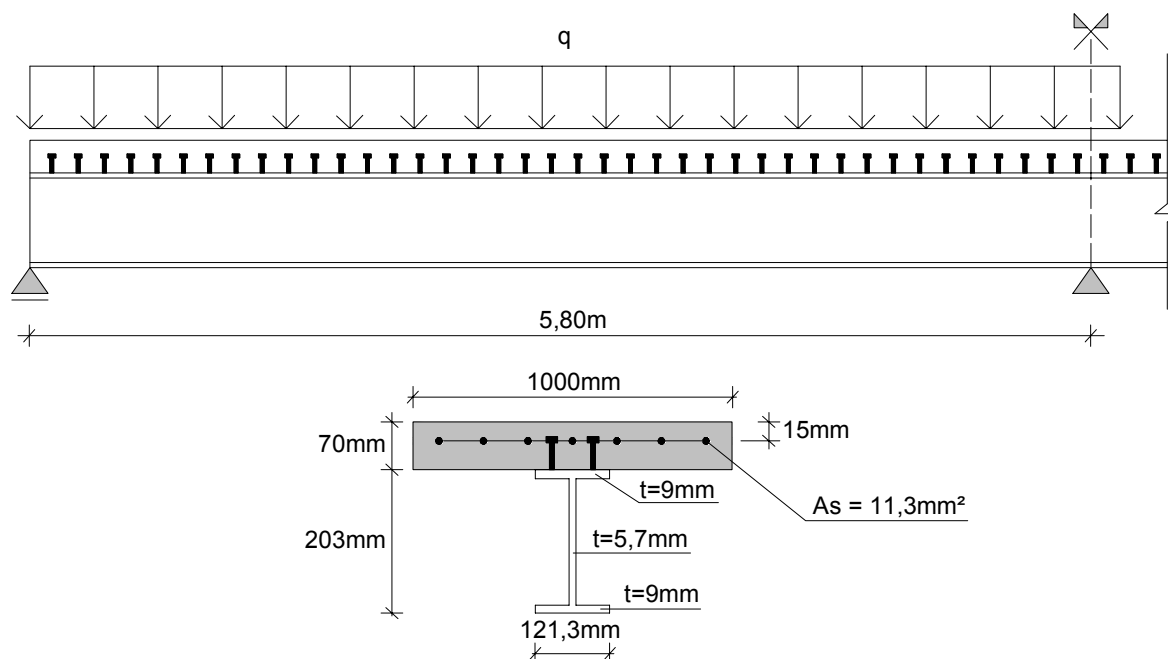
Geometria e detalhes da seção das vigas mistas contínuas B1 e B2
